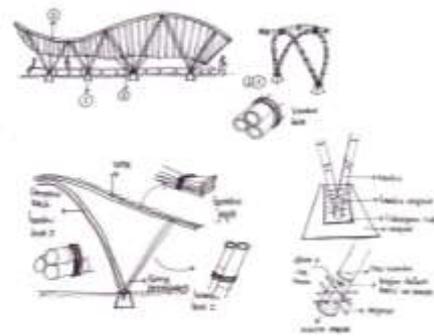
Potongan bangunan Pos Ronda (kiri) dan konstruksi kurva bambu (kanan)
